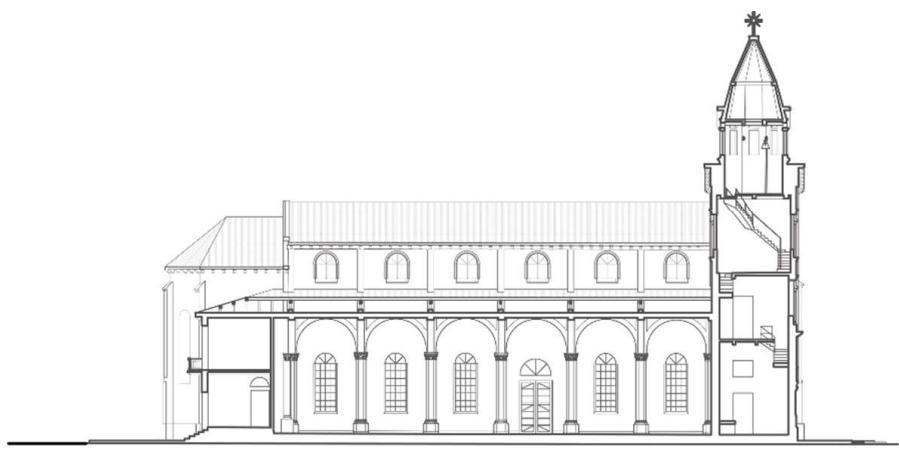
Fachadas y corte. Fuente: Orozco (2020).
